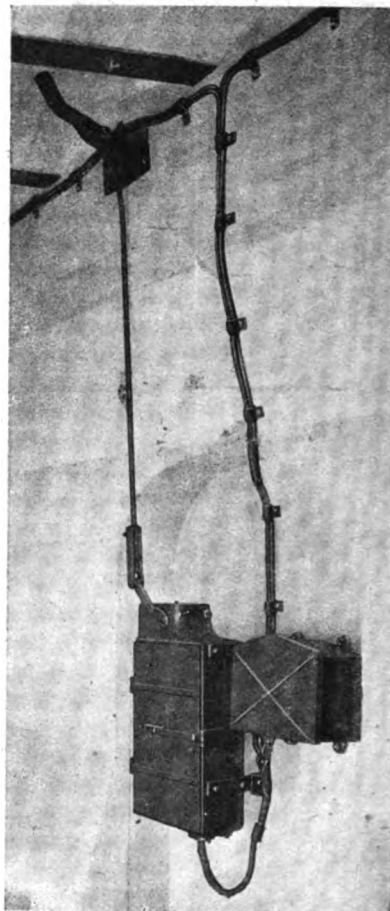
Fahrsperrung mit Siemens & Halske-Antrieb und Relais an einer Tunnelwand.
